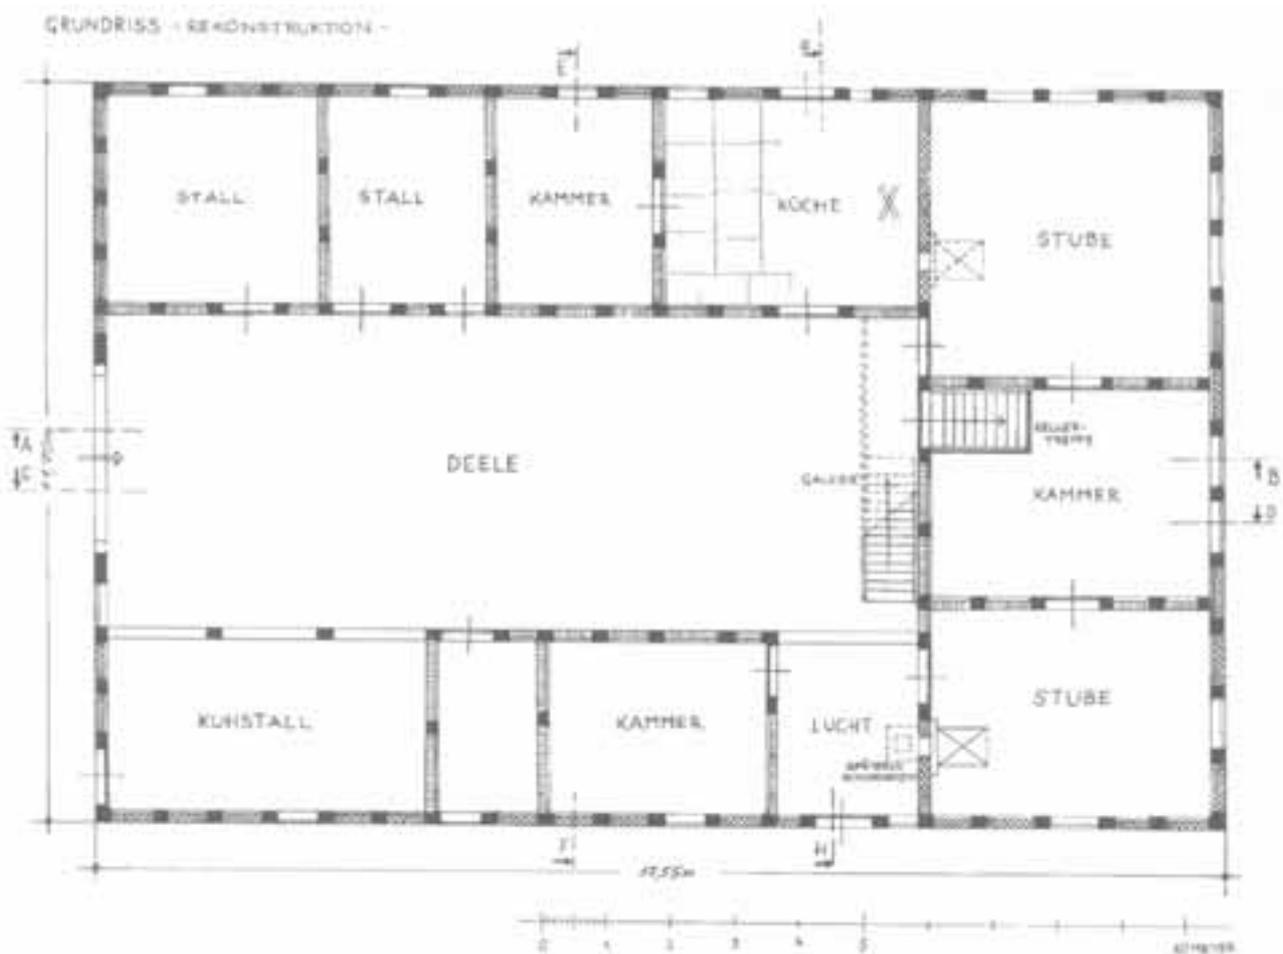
Exemplarischer Grundriss eines niederdeutschen Hallenhauses
